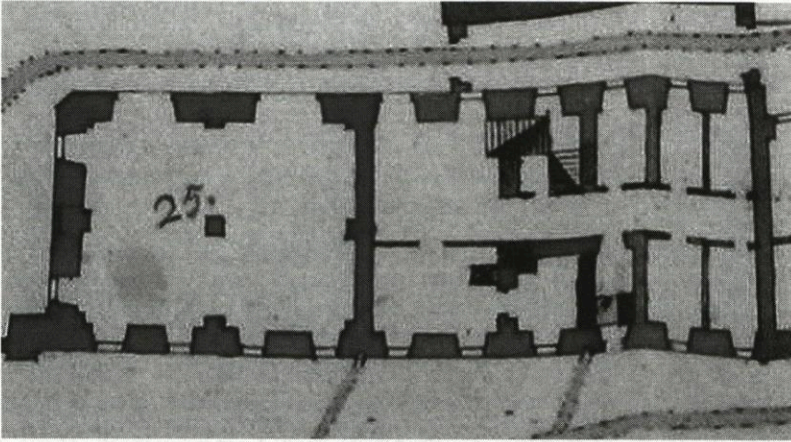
Obermünsterstraße 8 vor 1766 (Münchner Plan).
